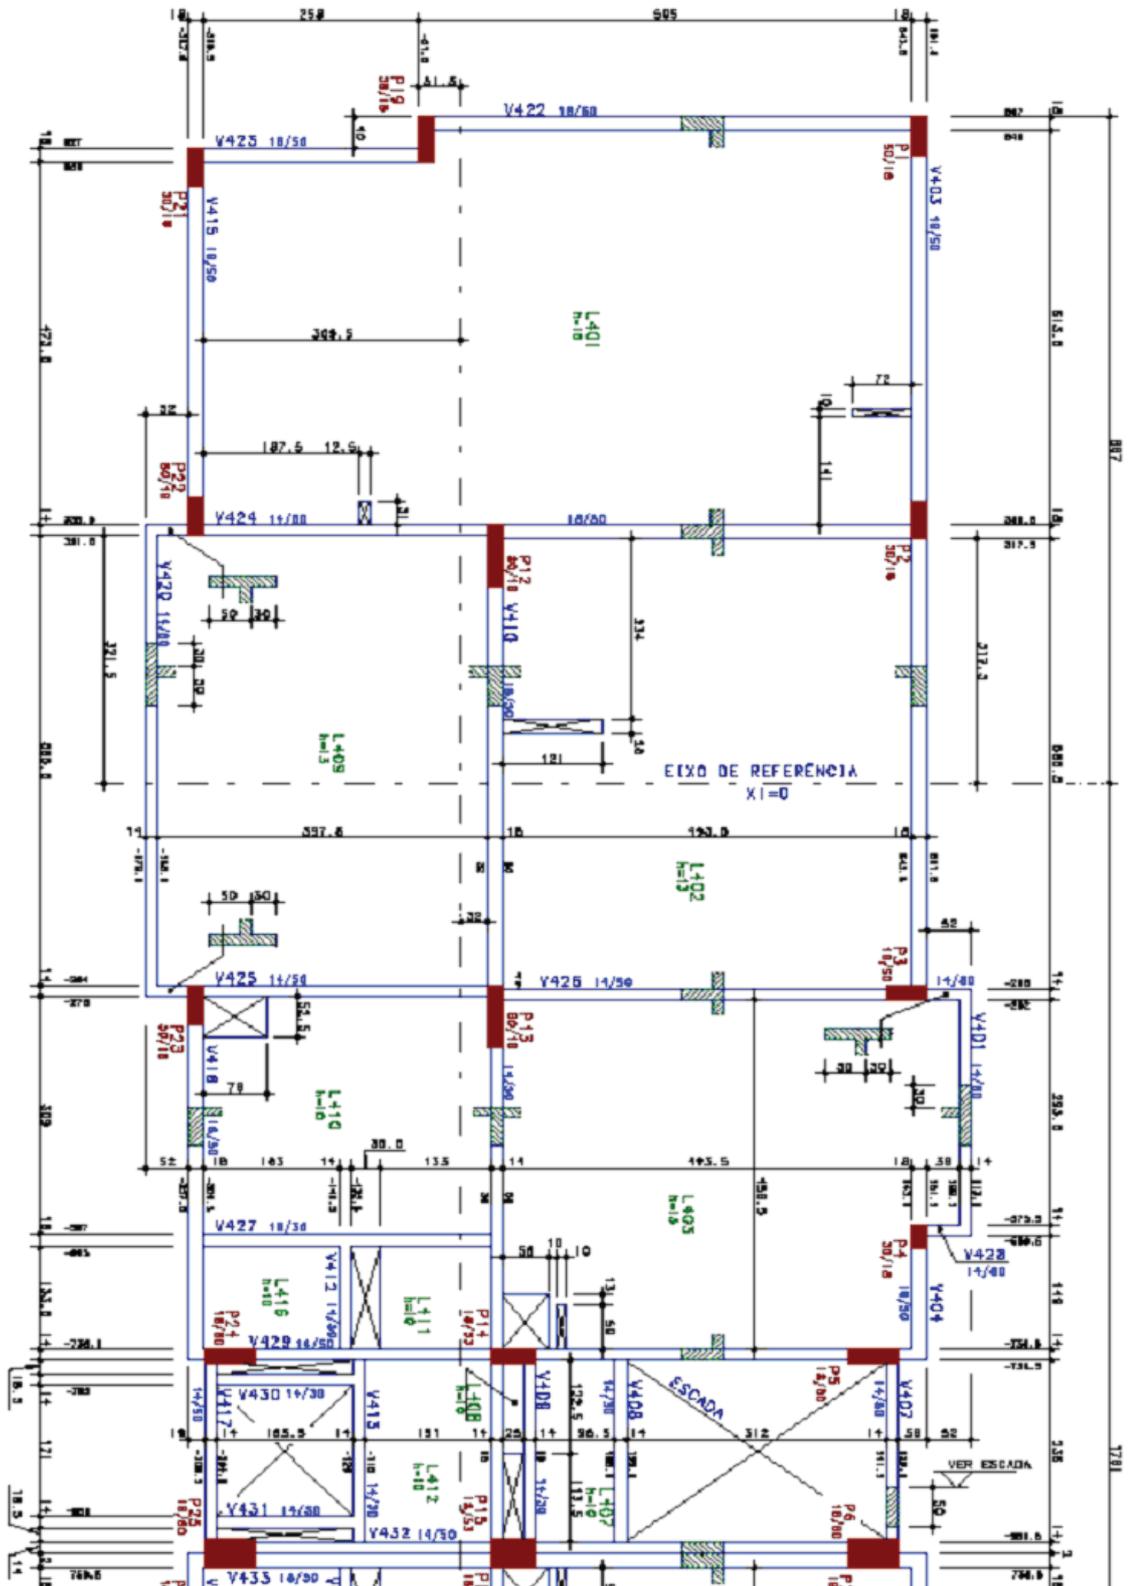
planta de fôrmas reduzida do pavimento tipo em laje convencional<sup>20</sup>
